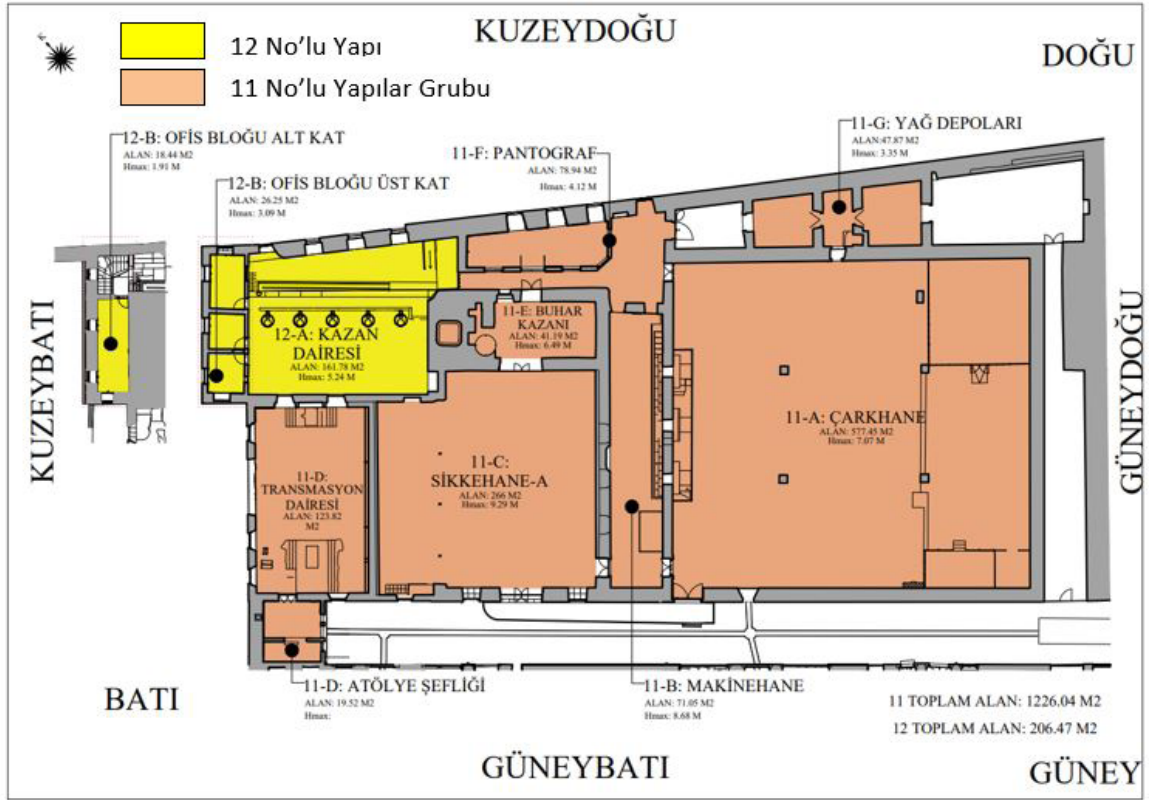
Vaziyet planı üzerinde 11-12 No'lu yapılar
